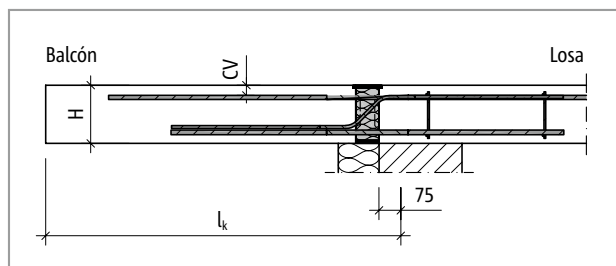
Schöck Isokorb® T tipo K-M13 hasta M14: Sistema estático
